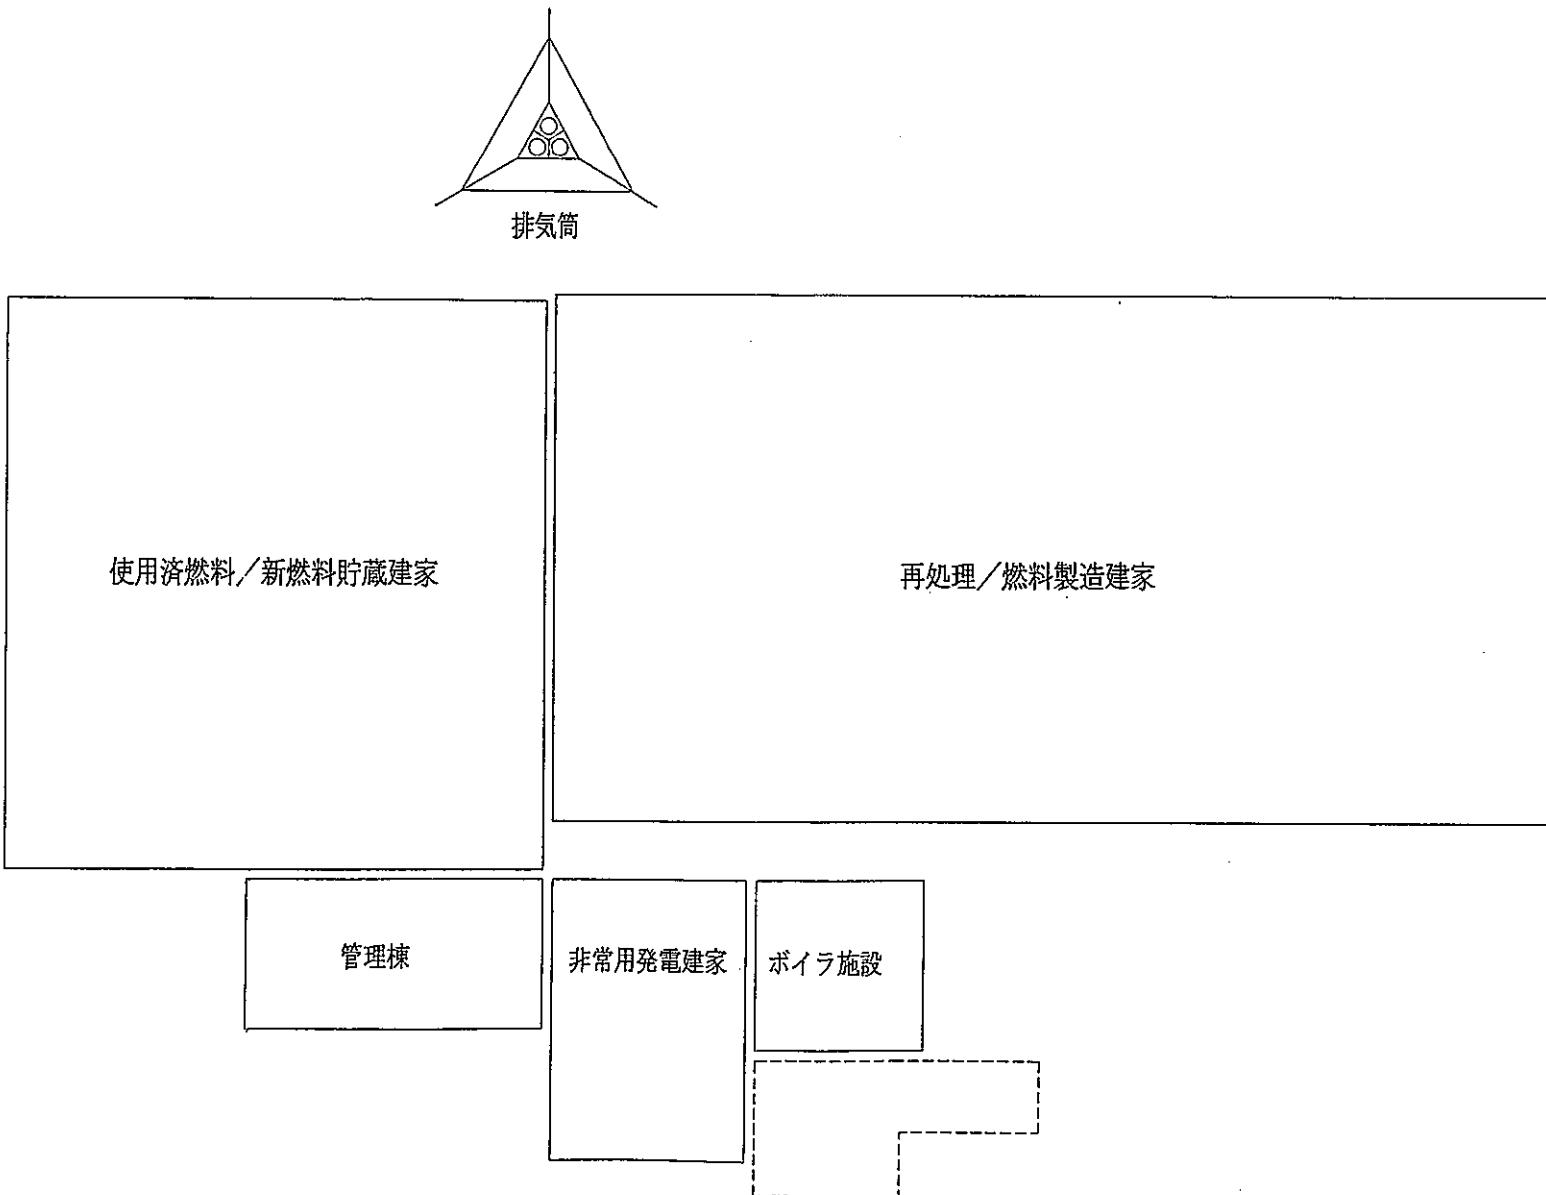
50 t HM／年施設の全体配置図（平面図）
